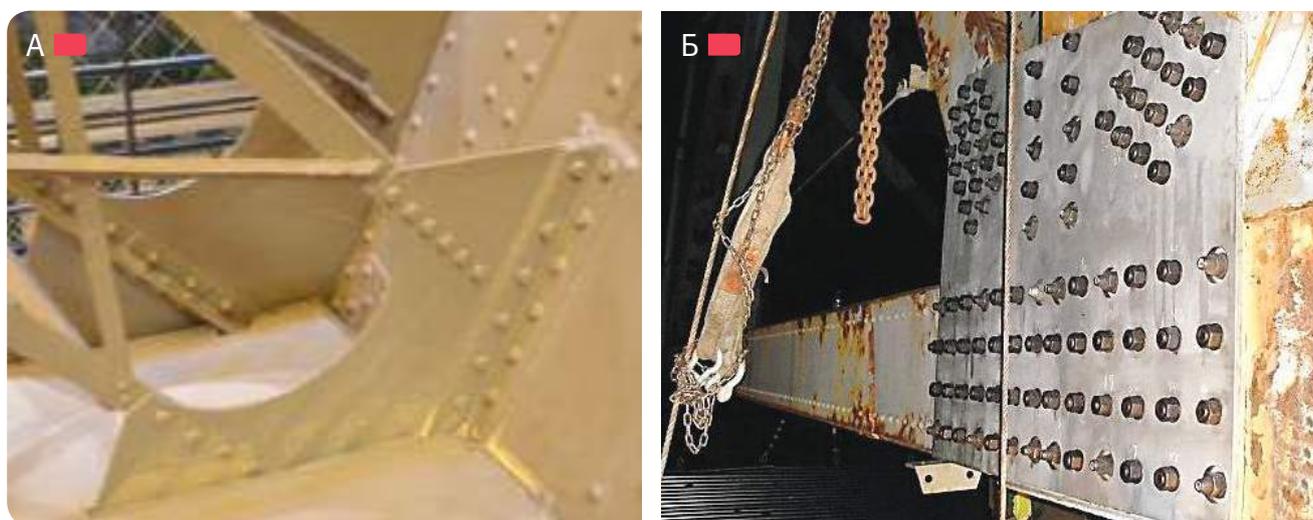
Примеры усиления узлов: А – стальных элементов Эйфелевой башни увеличением сечения накладками и обвариванием; Б – мостовых ферм листовыми фасонками на болтах
